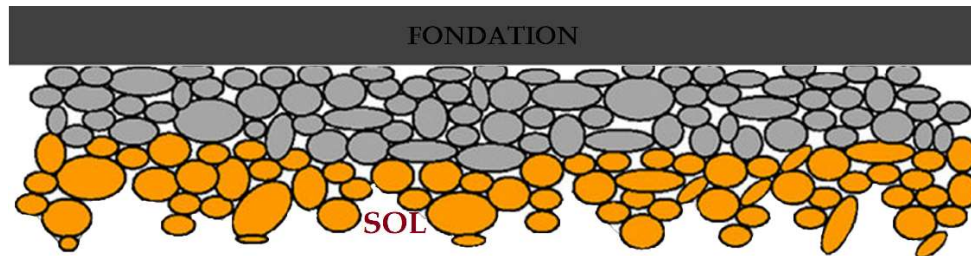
Fondation reposant sur un sol qui est constitué de différentes couches.
